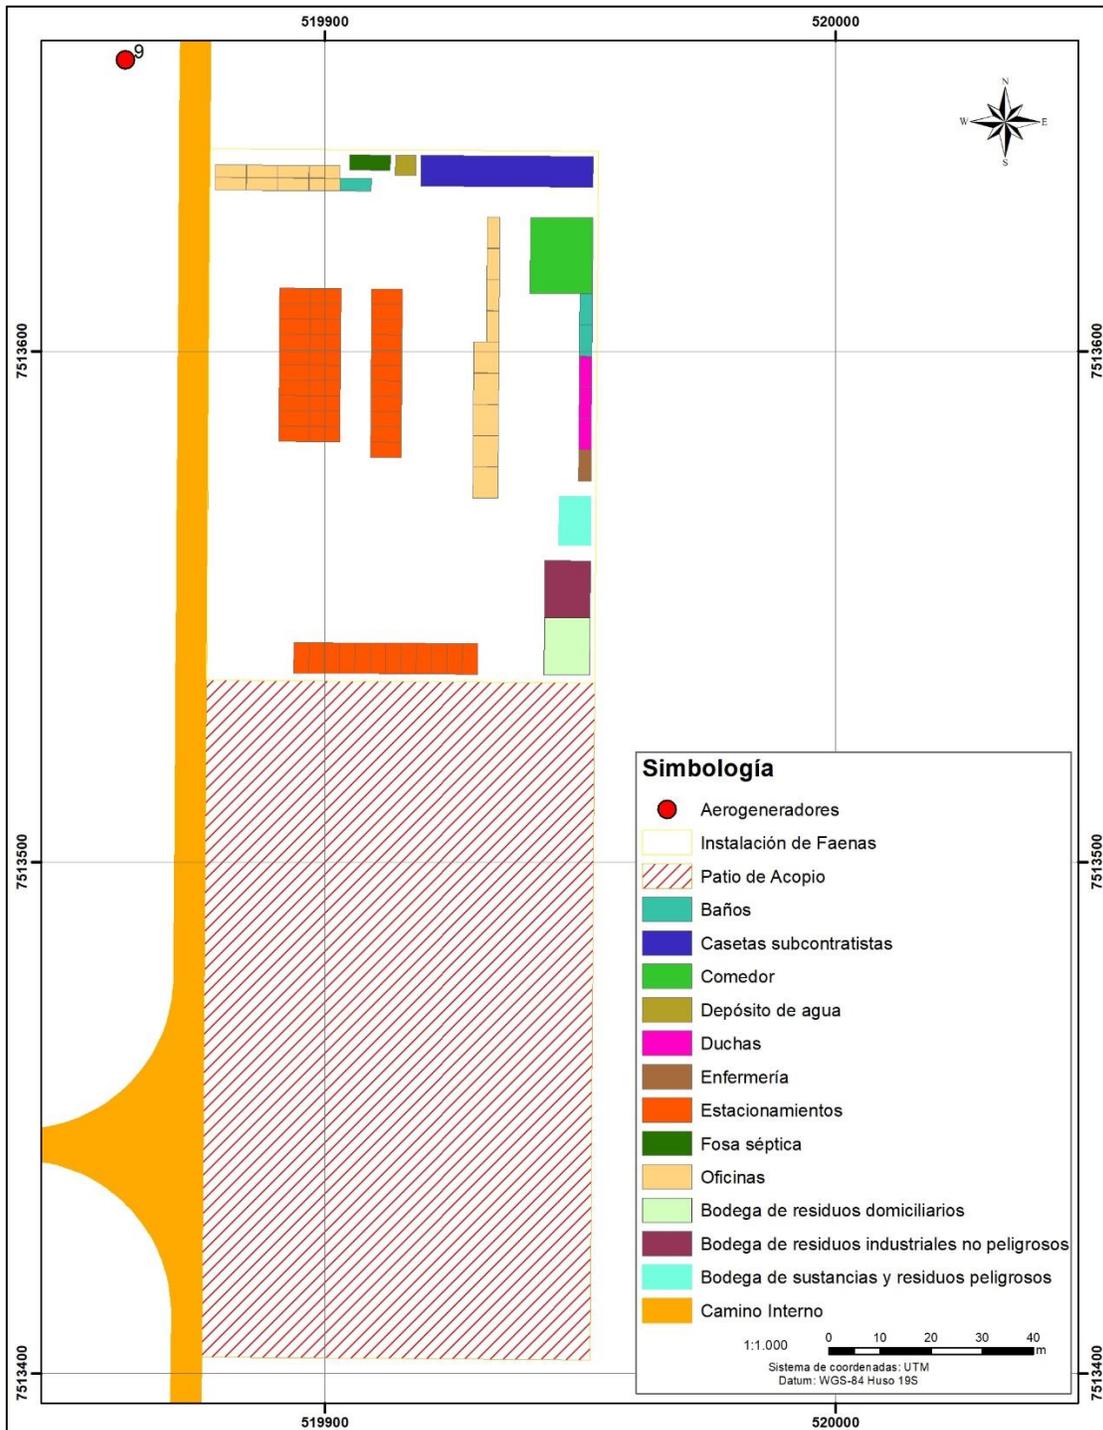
Emplazamiento de obras temporales en la etapa construcción.
